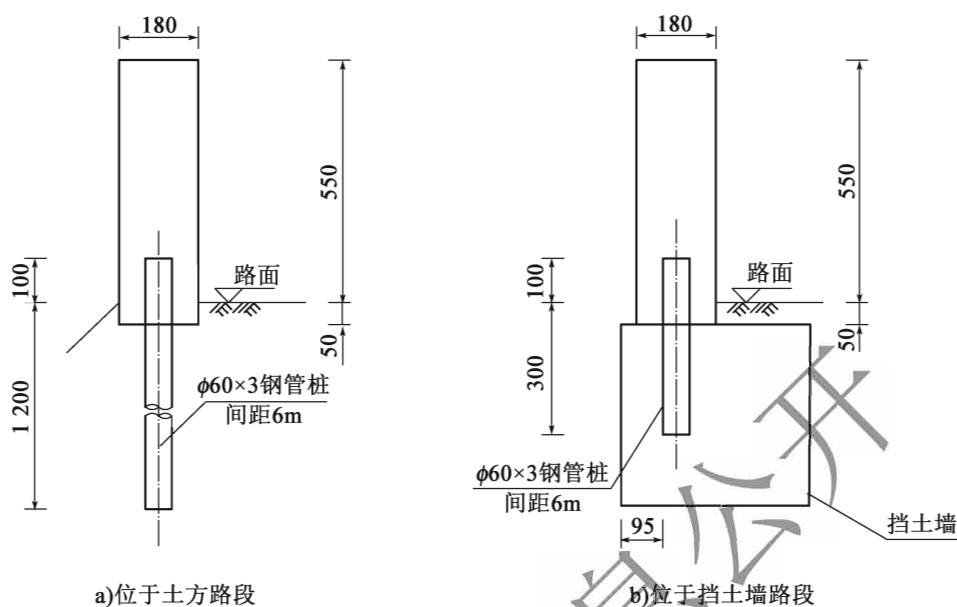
D 级路基混凝土护栏横断面布置(尺寸单位: mm)
